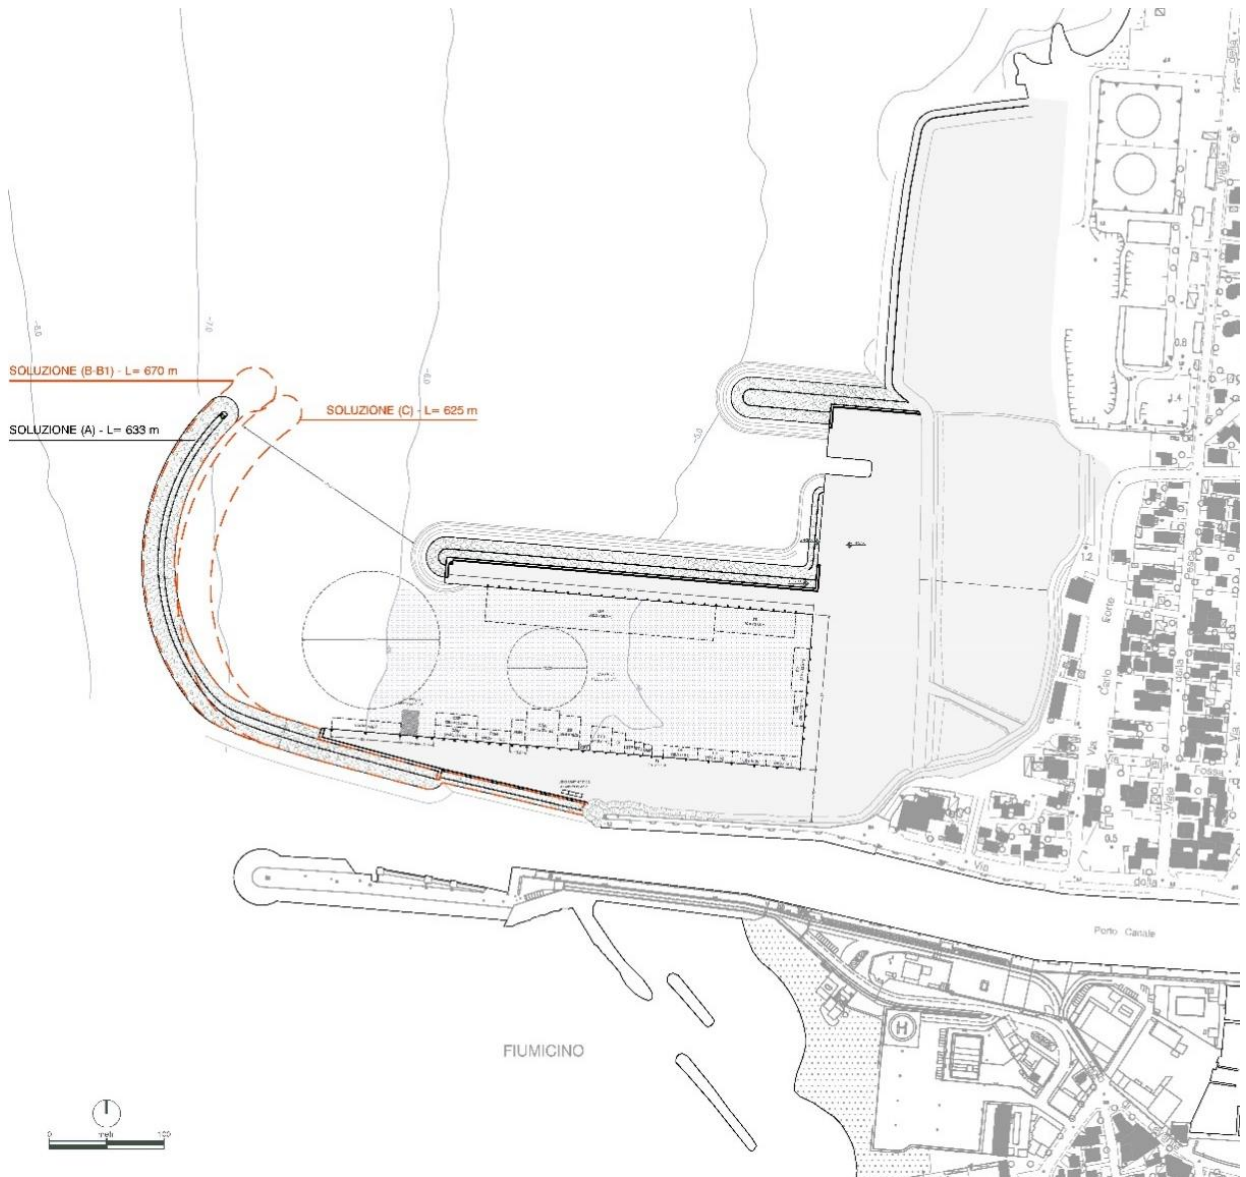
Sovrapposizione planimetrica delle quattro soluzioni proposte
